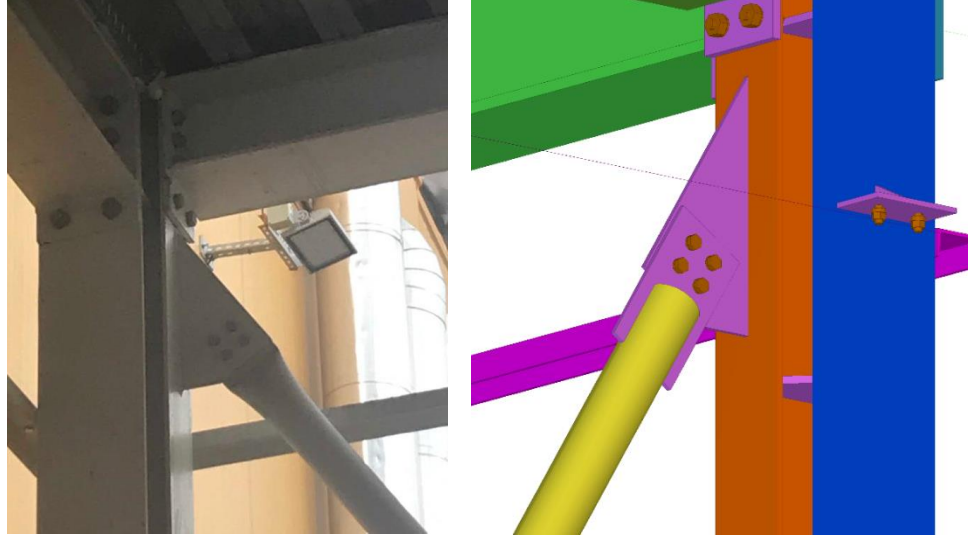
Kolon – Kiriş bağlantısı (Tip3)
